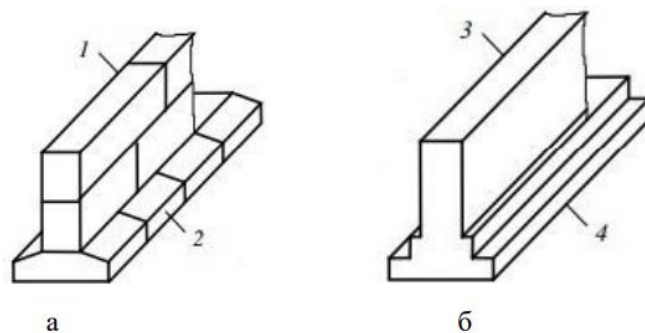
Стрічкові фундаменти: а) – збірний безперервний; б) - монолітний
